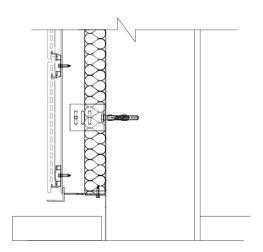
Kit Tempio® FK. Arranque de fachada.
